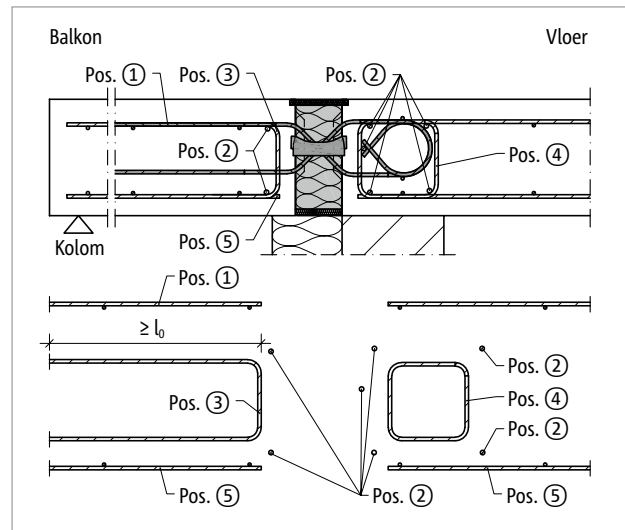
Schöck Isokorf® T type Q-E-V: Bijlegwapening
